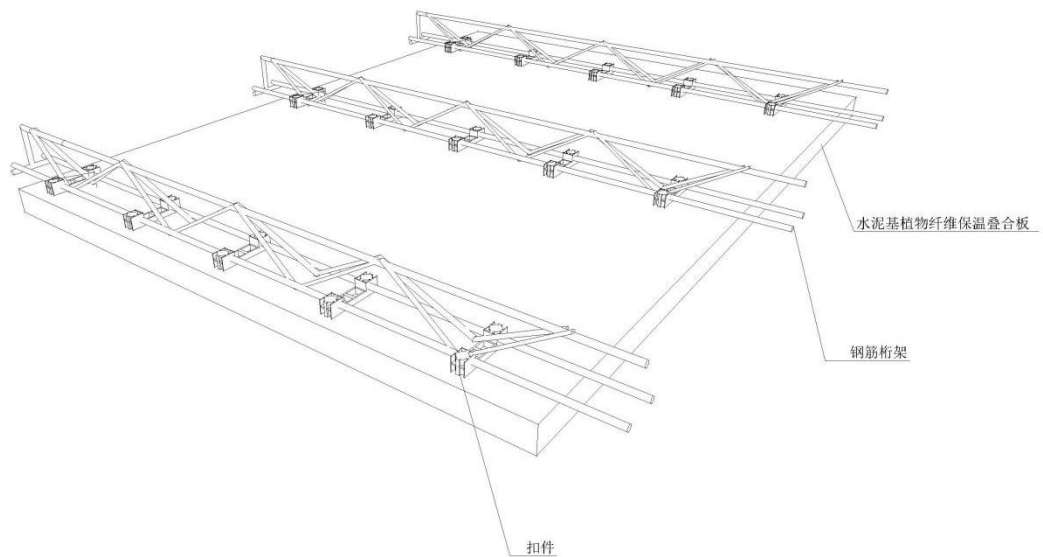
钢筋桁架水泥基植物纤维保温叠合板示意图
